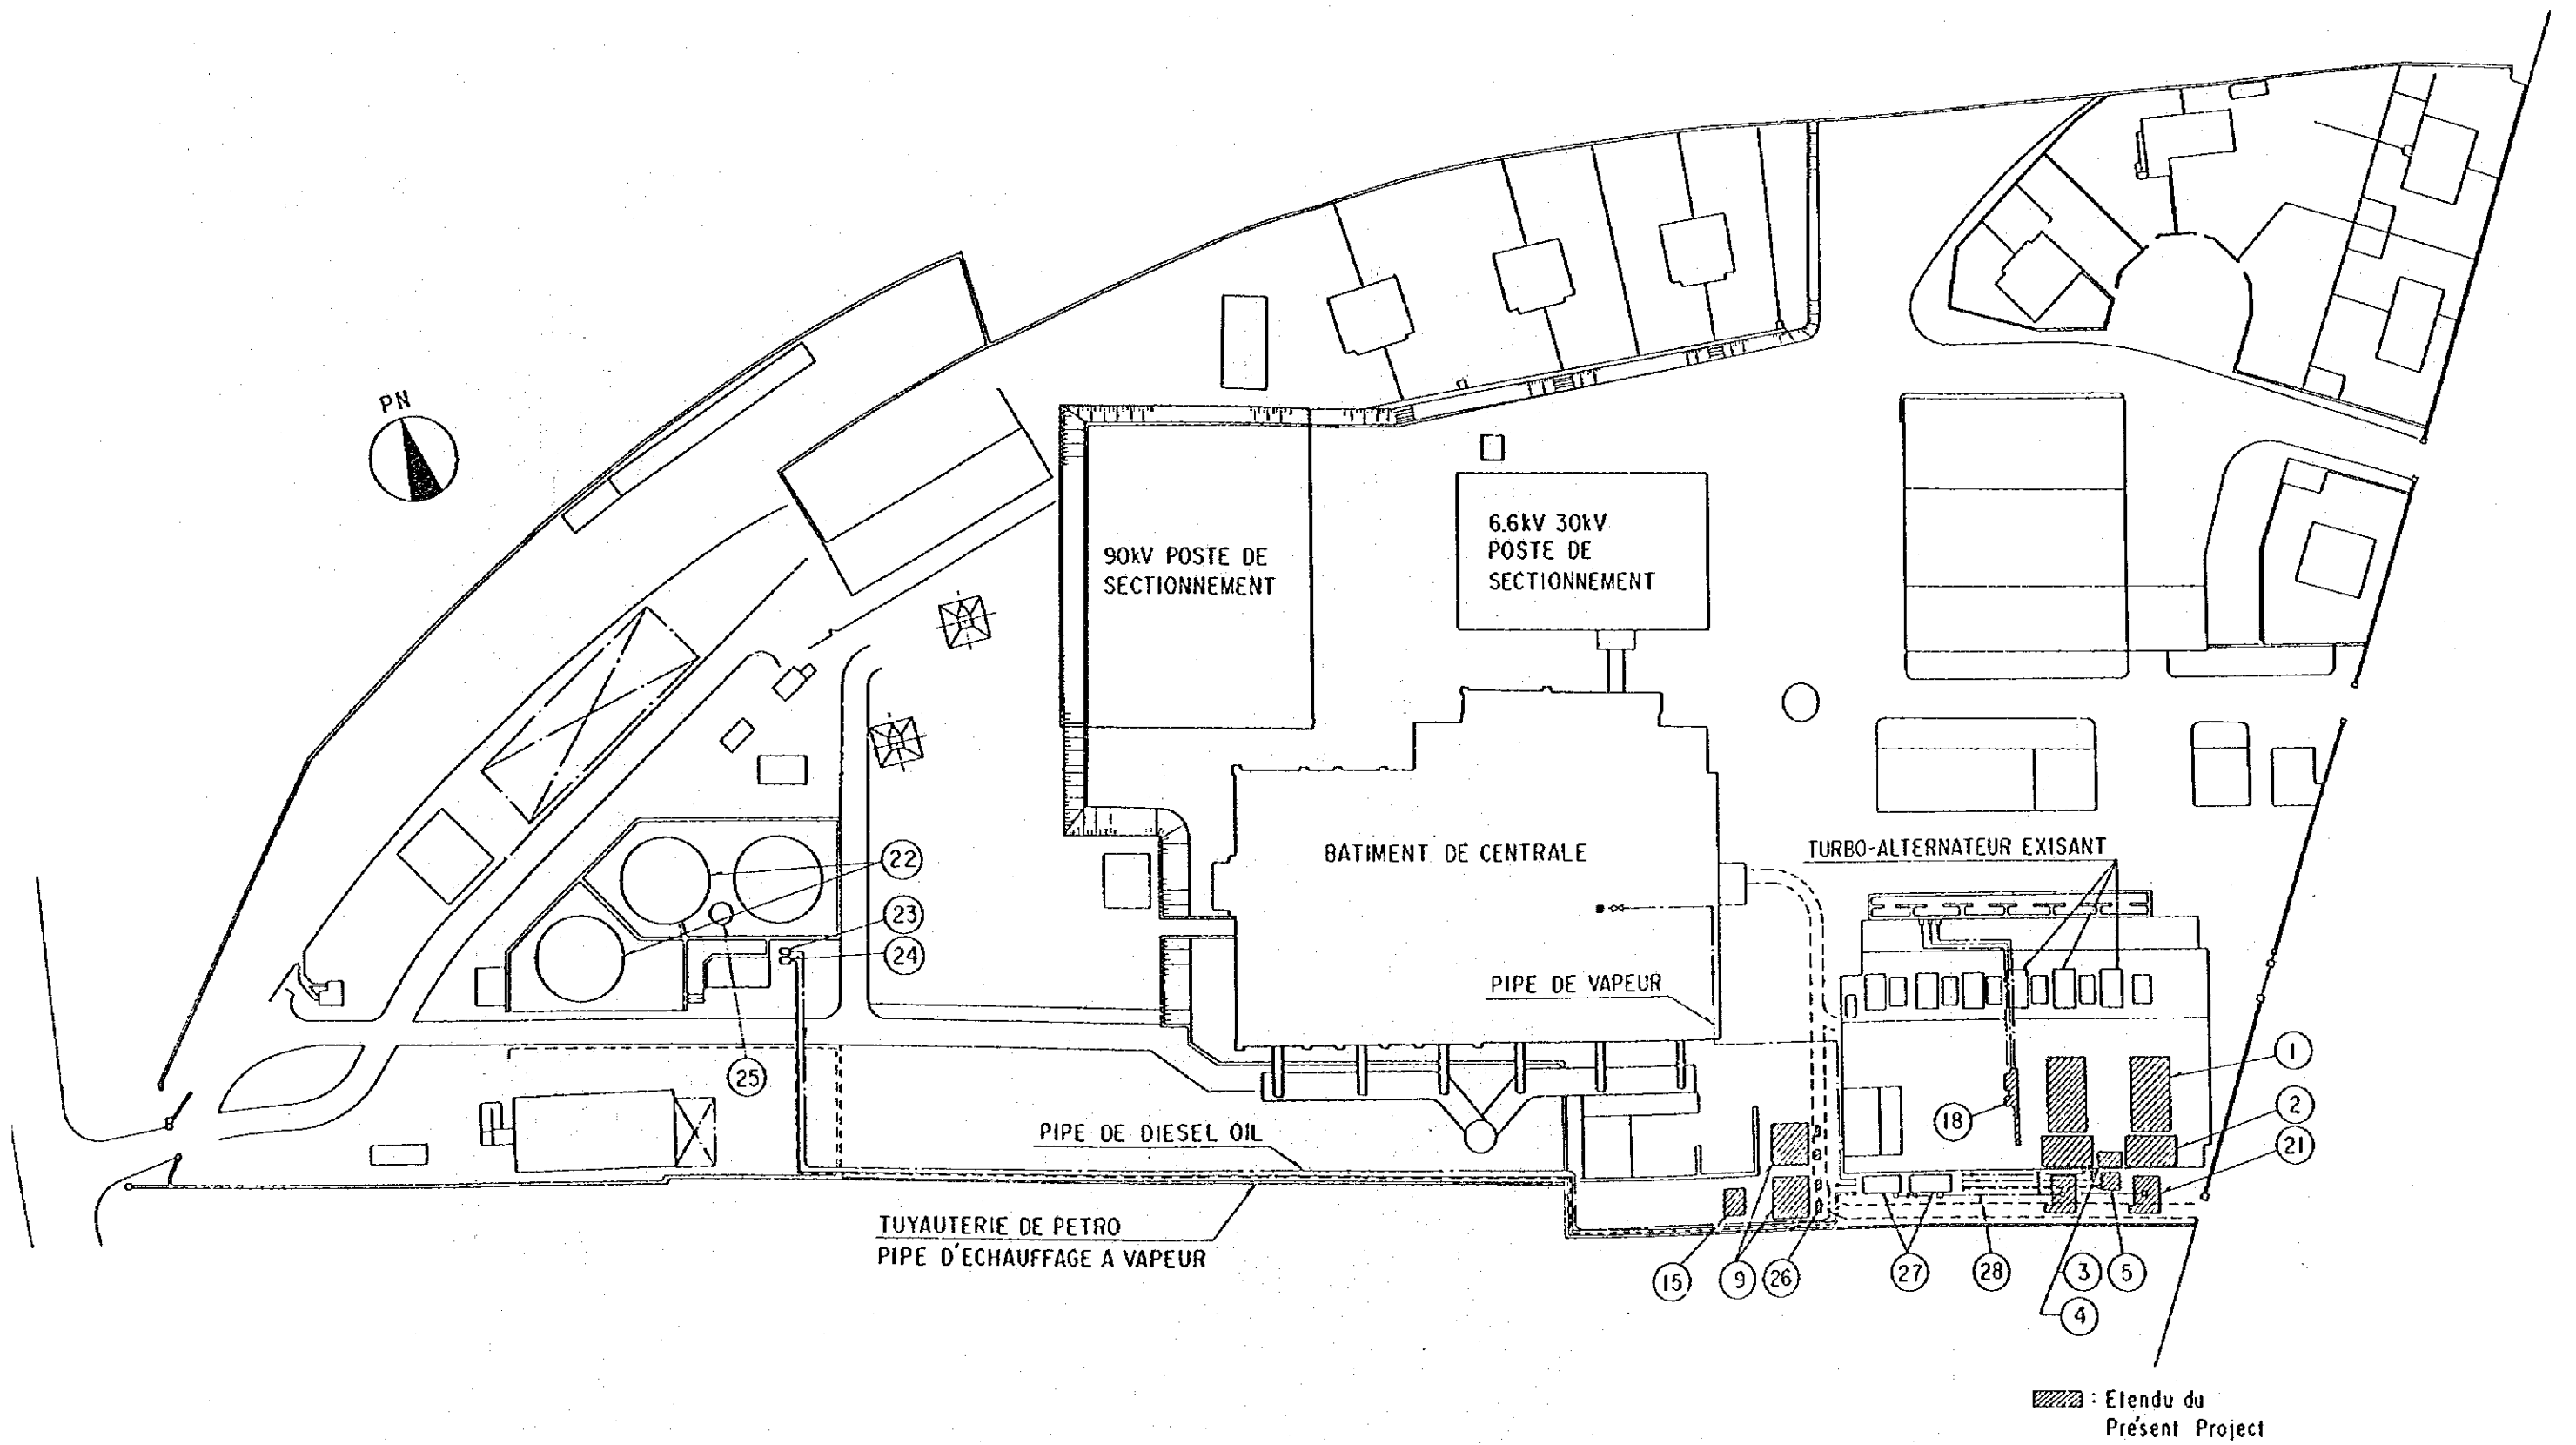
PLAN DE MASSE DE LA CENTRALE DE BEL AIR
